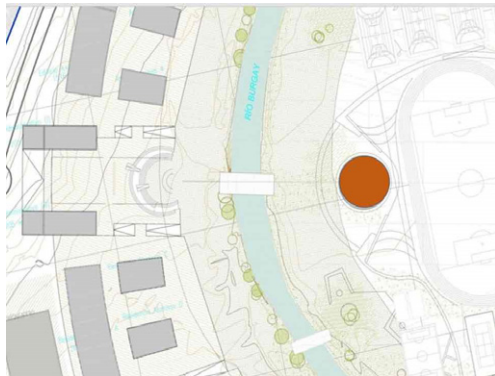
/ Imagen del Plan Masa- Planta de localización del CRAI
